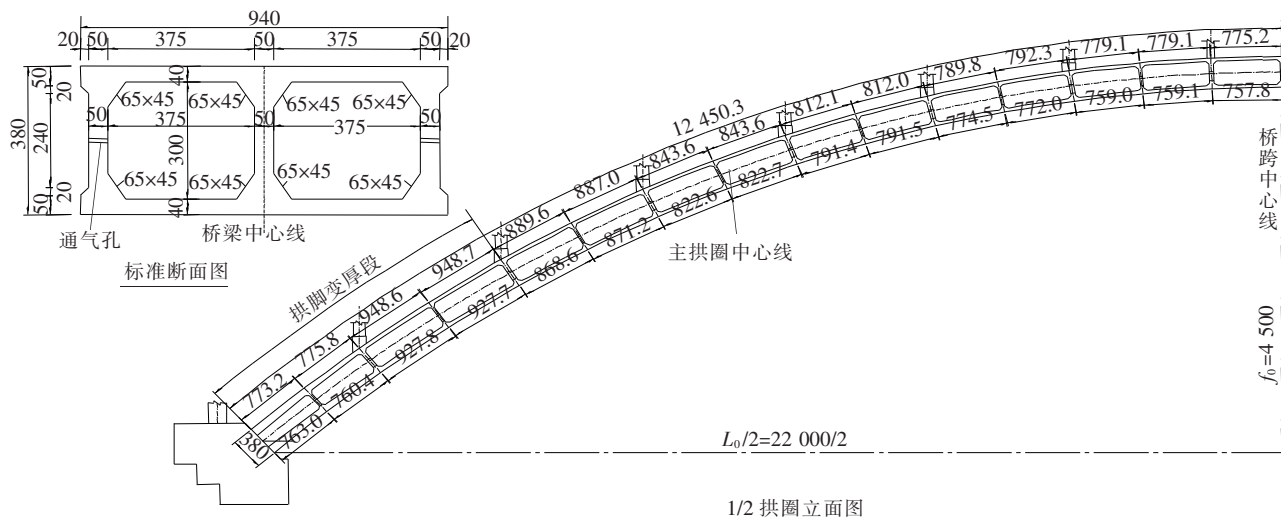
三沙大桥主拱圈构造布置图(单位:cm)
